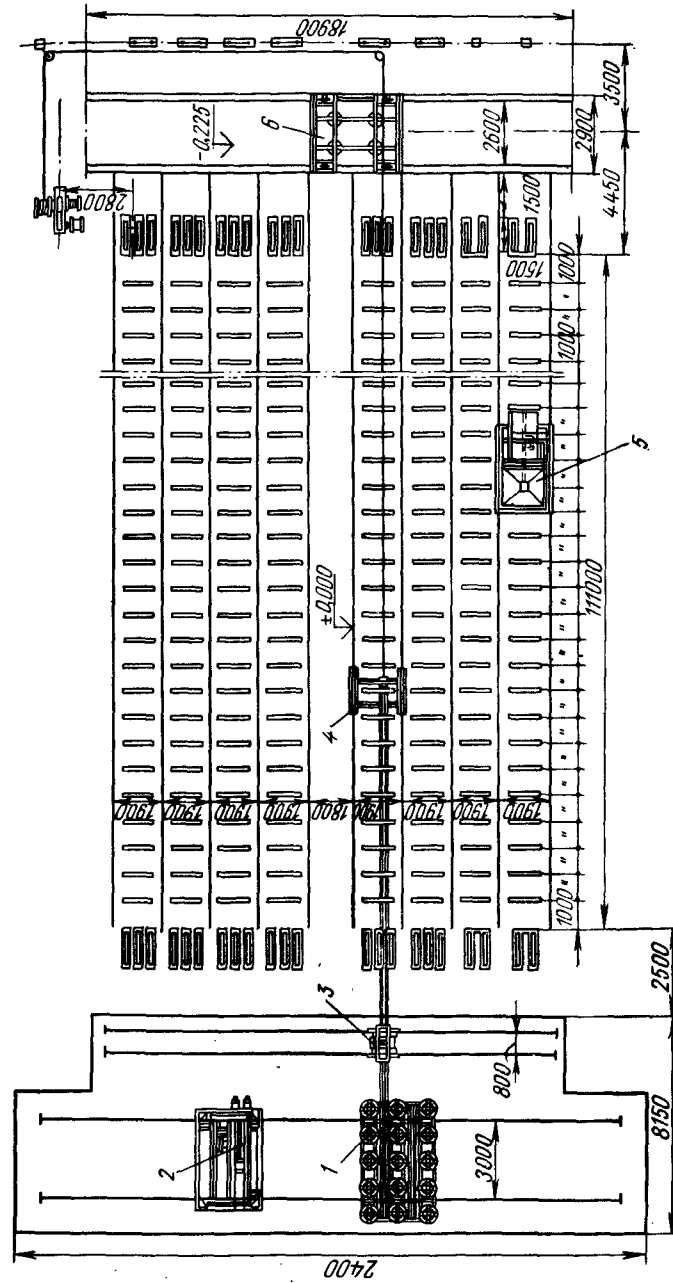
Протяжной стенд для изготовления предварительно напряженных струнбетонных балок:
